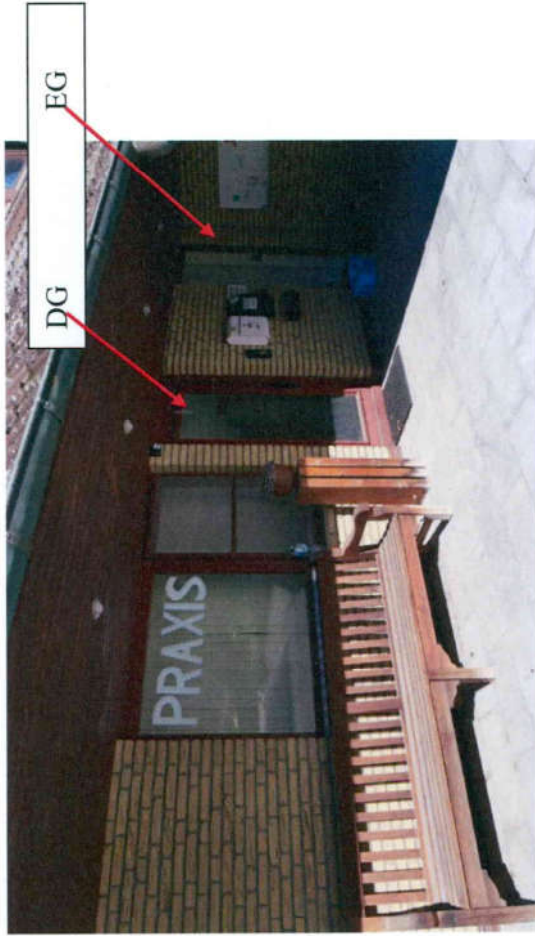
Eingangsbereich Erd- und Dachgeschoss
